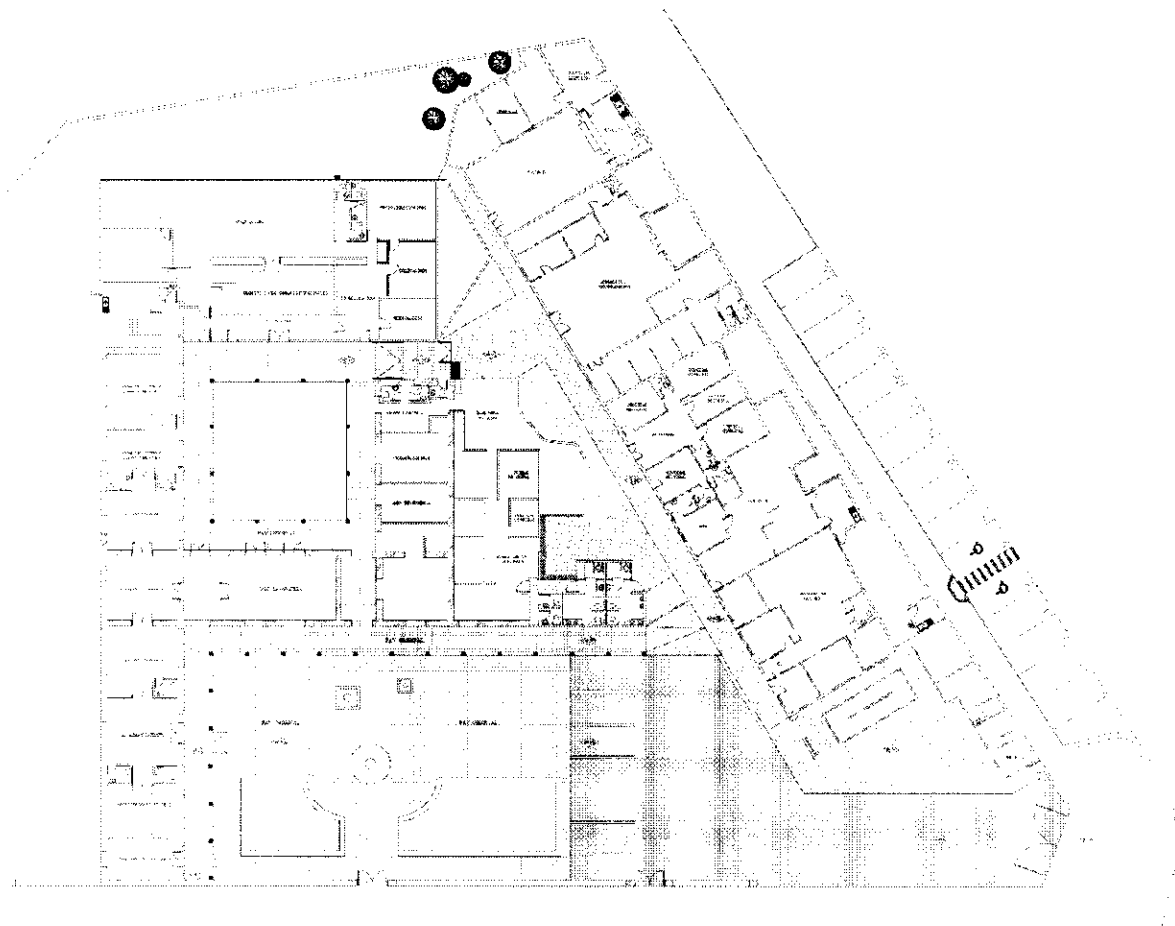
Planimetría Situación Propuesta – Edificio Consistorial
